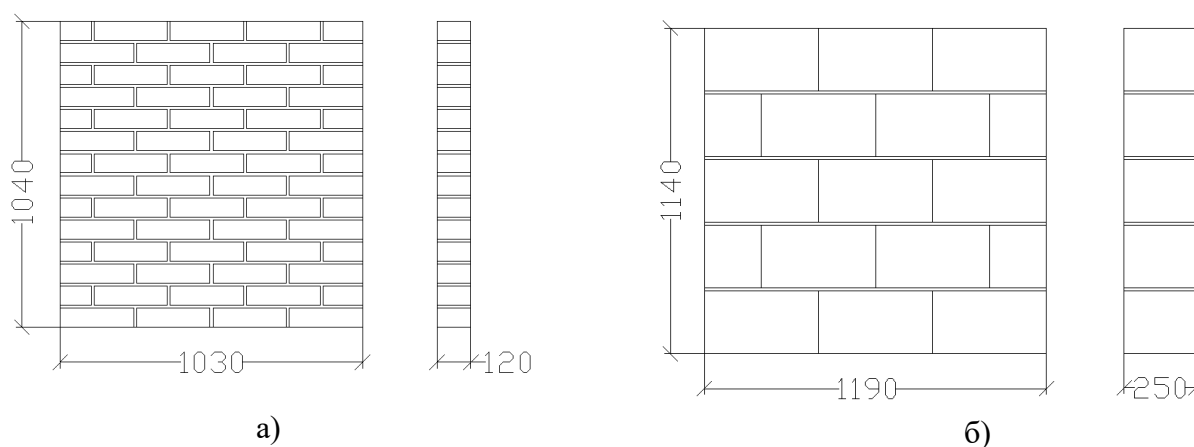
Фрагменты кладки стен для испытаний на «перекос»:
